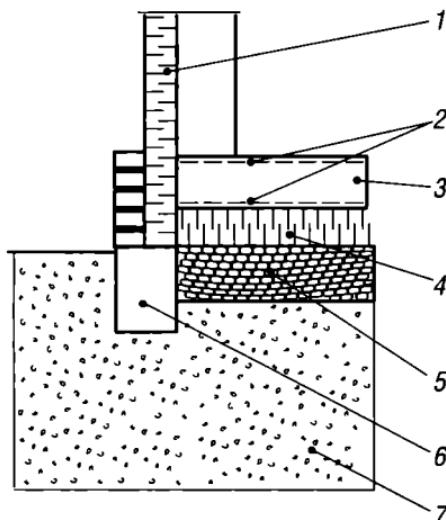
Устройство плитного фундамента на подушке из пенополистирола:
